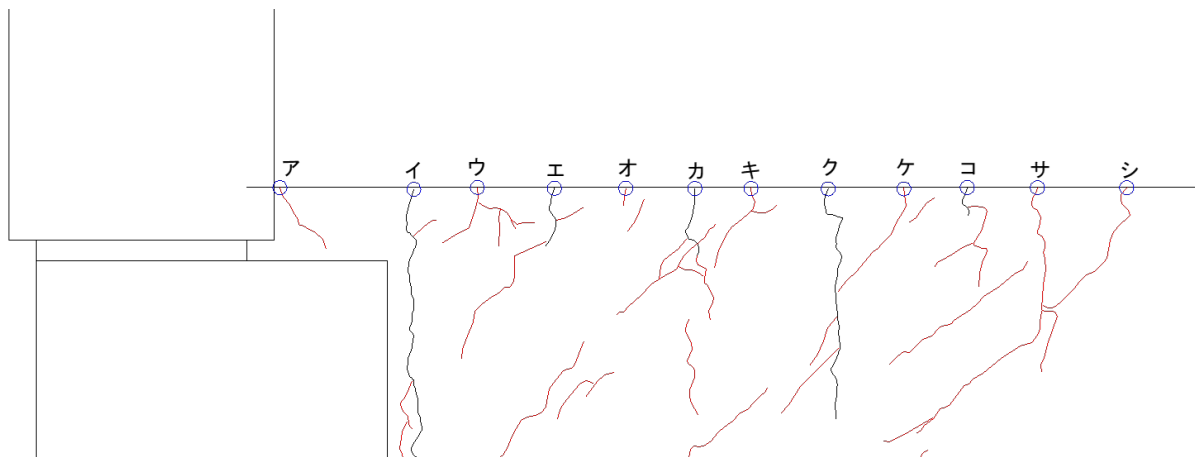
3. 244 基礎梁ひび割れ幅測定位置 (試験体 C-2 負荷荷)
